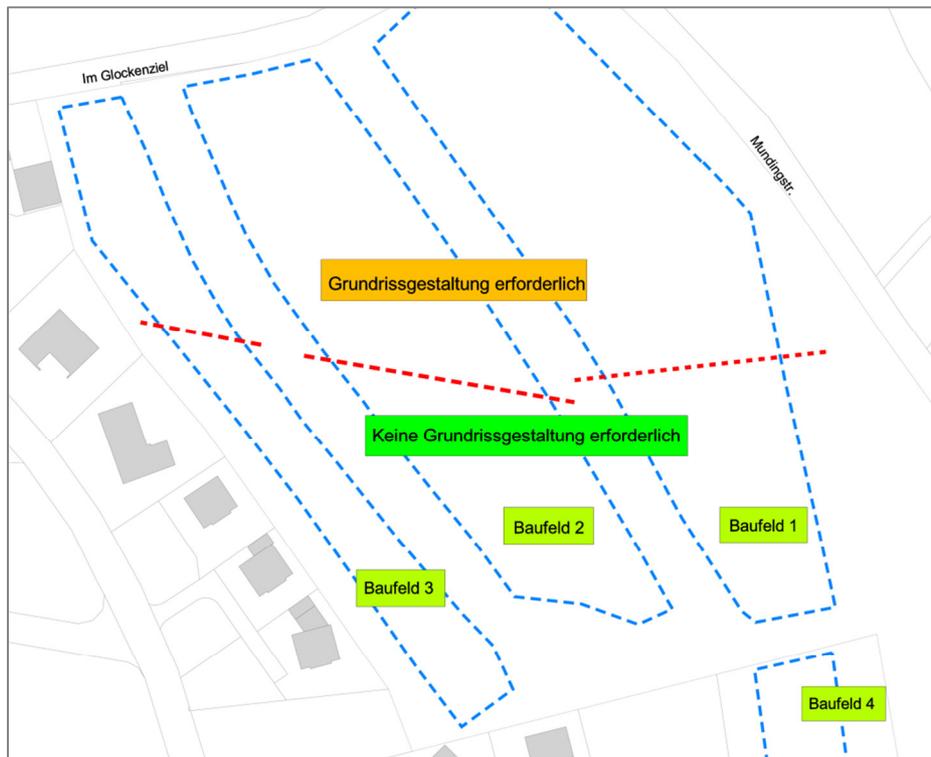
Erforderliche Grundrissgestaltung, bei einer Änderung des städtebaulichen Entwurfes „Glockenziel III“ (Stand 03.02.2016)
